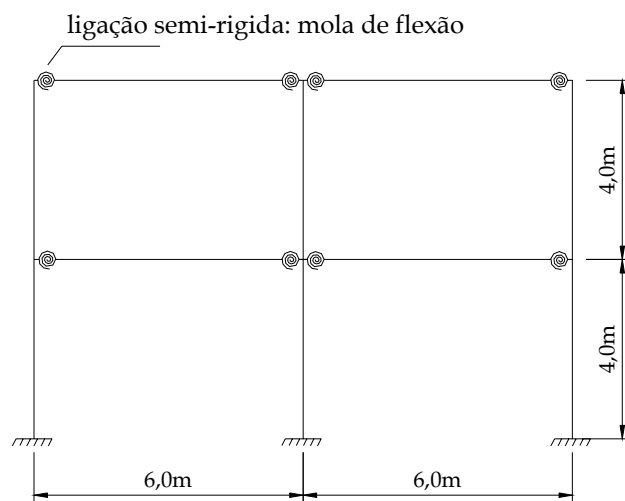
Esquema da estrutura com ligações viga-pilar semi-rígidas.
